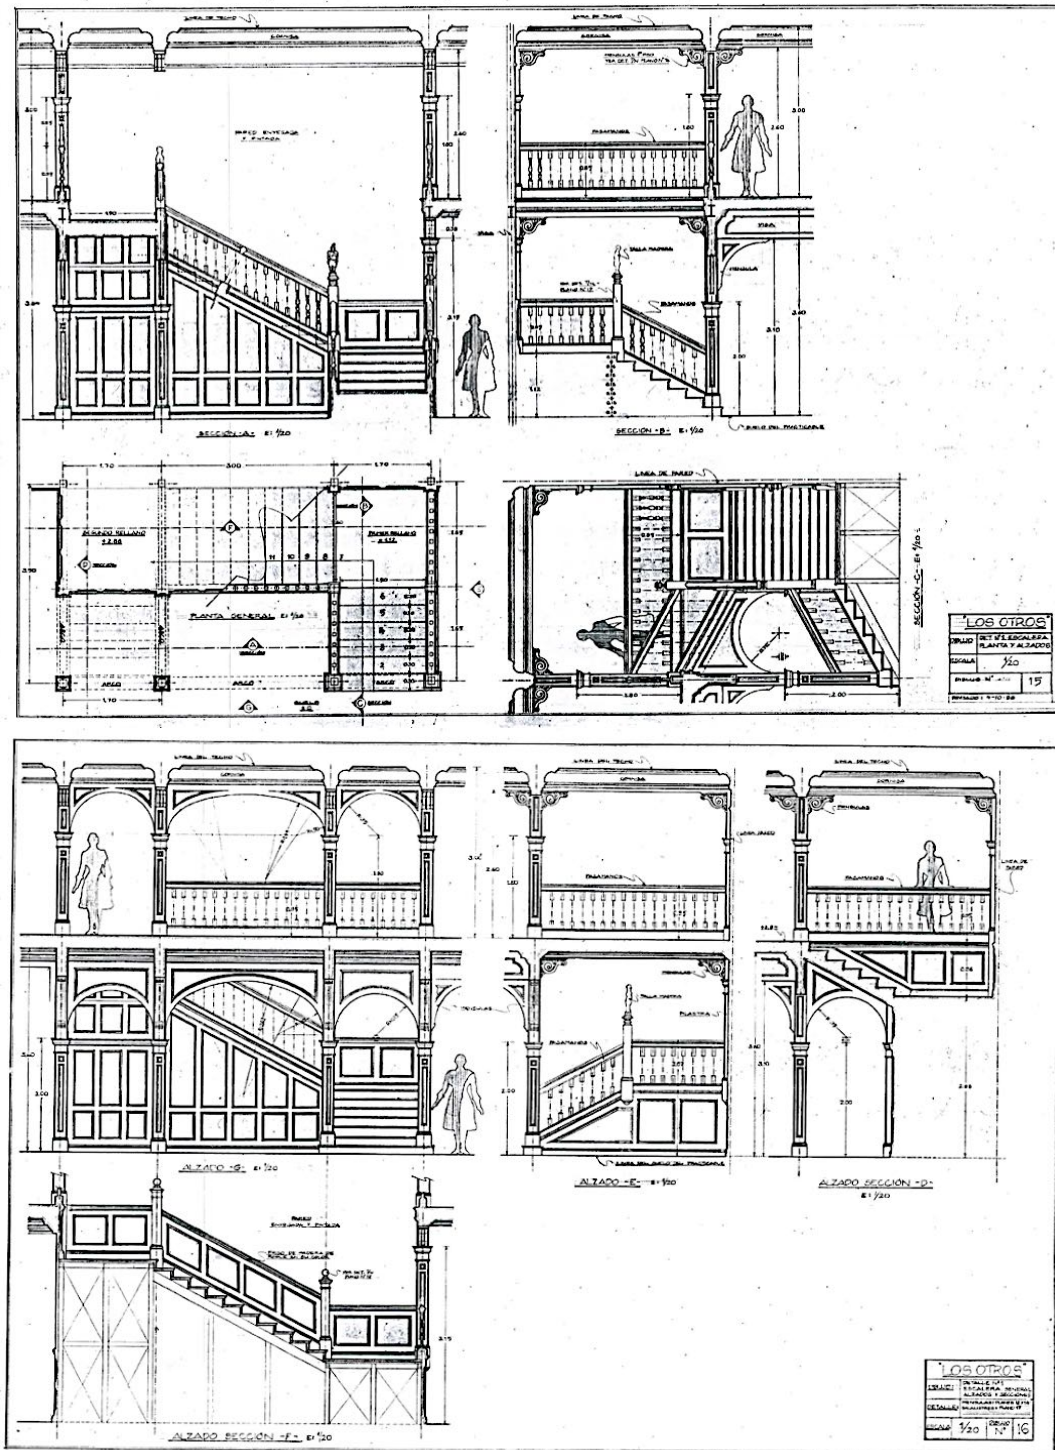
Planos. Planta, alzados y secciones de la escalera. *Los otros*.
